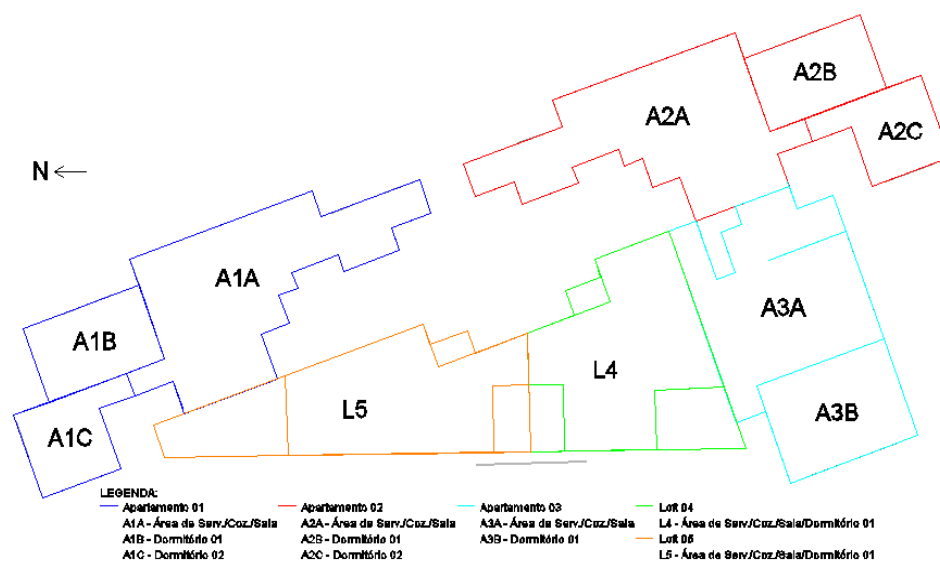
Identificação das zonas térmicas do pavimento tipo
